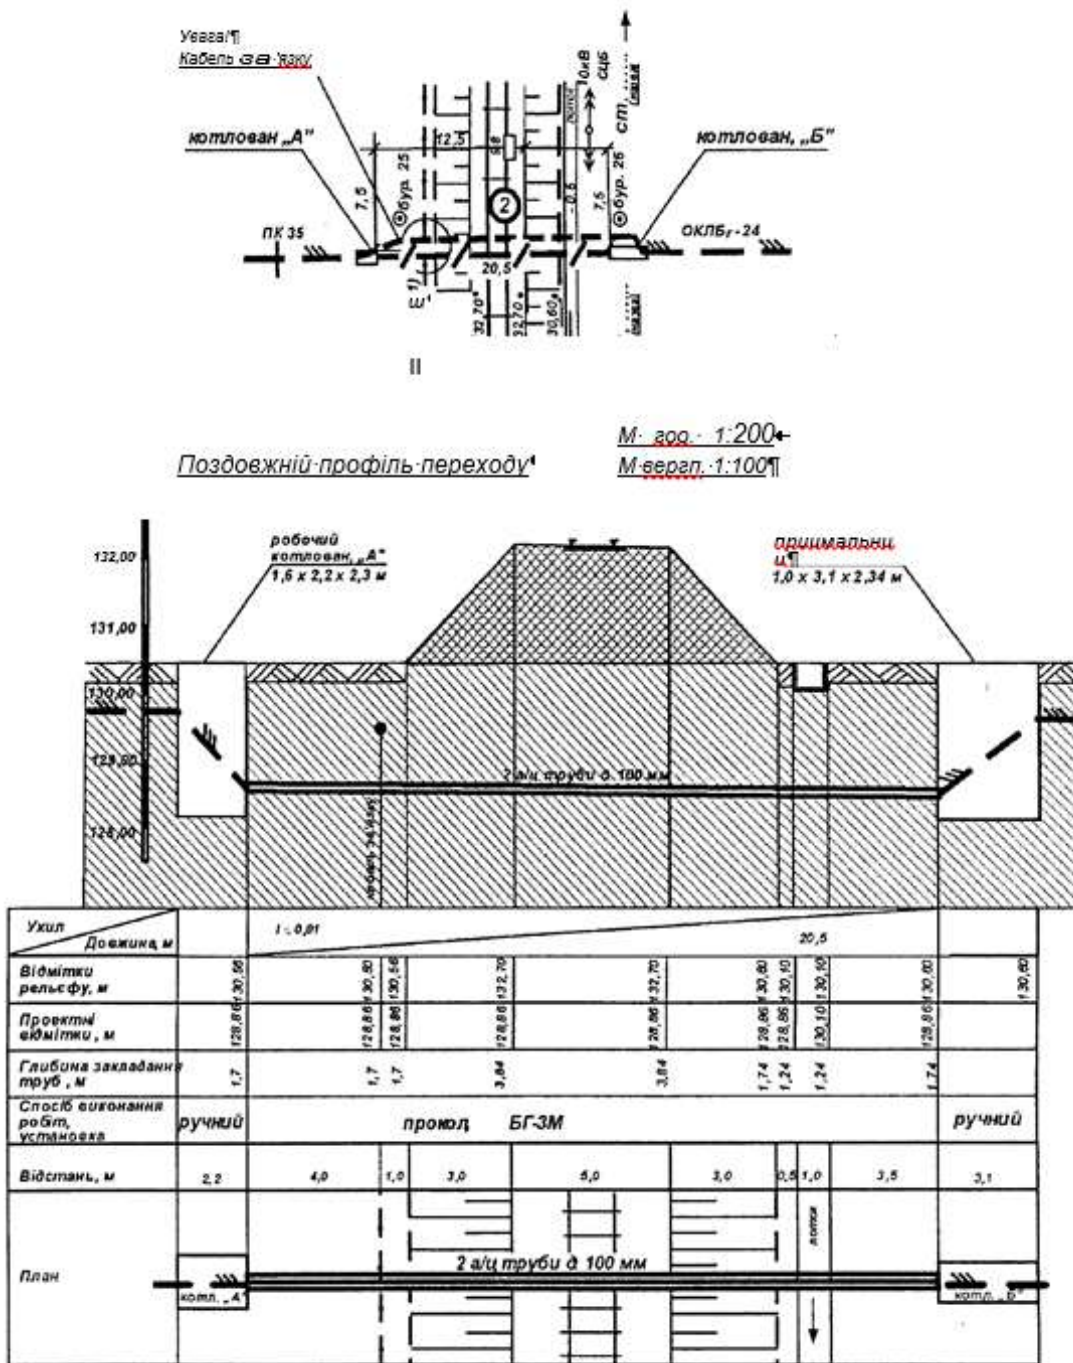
План розташування та поздовжній профіль кабельного переходу через залізничну колію
